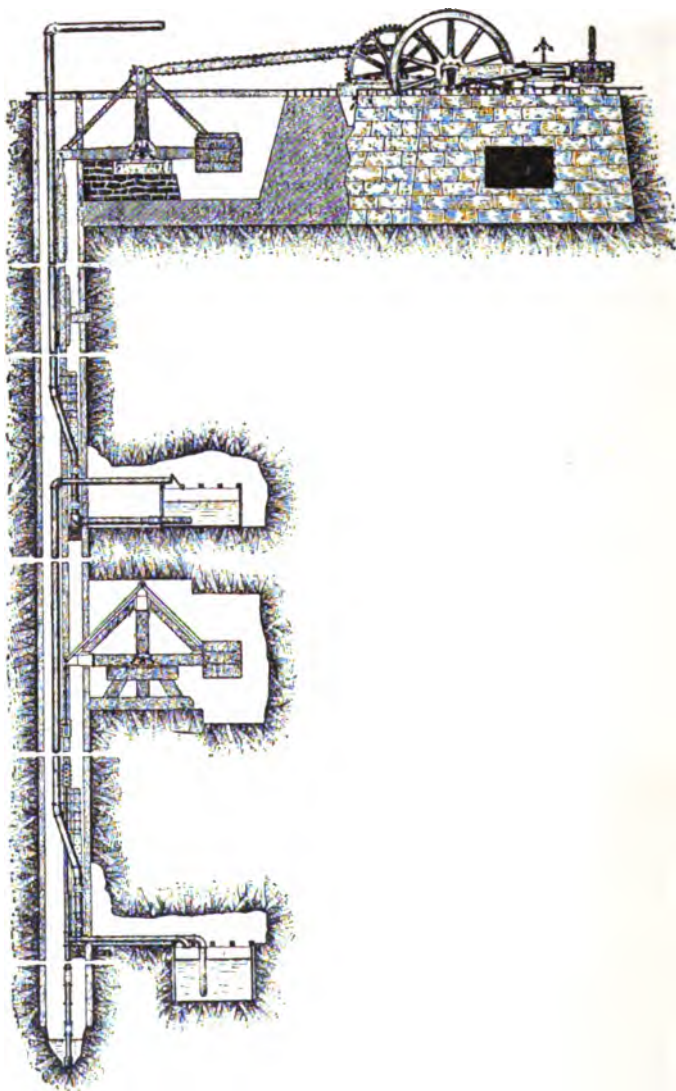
Disposition générale d'une pompe de Cornouailles dans un puits vertical.
